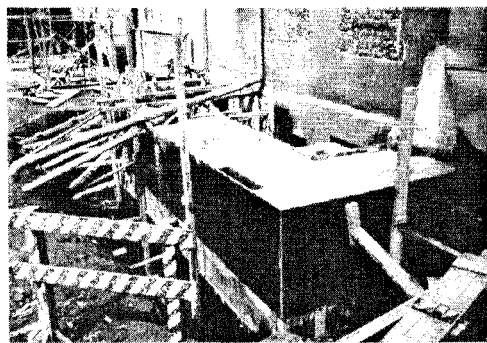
Бетонування фундаментів металевого каркаса сходової клітки та шахти ліфта
